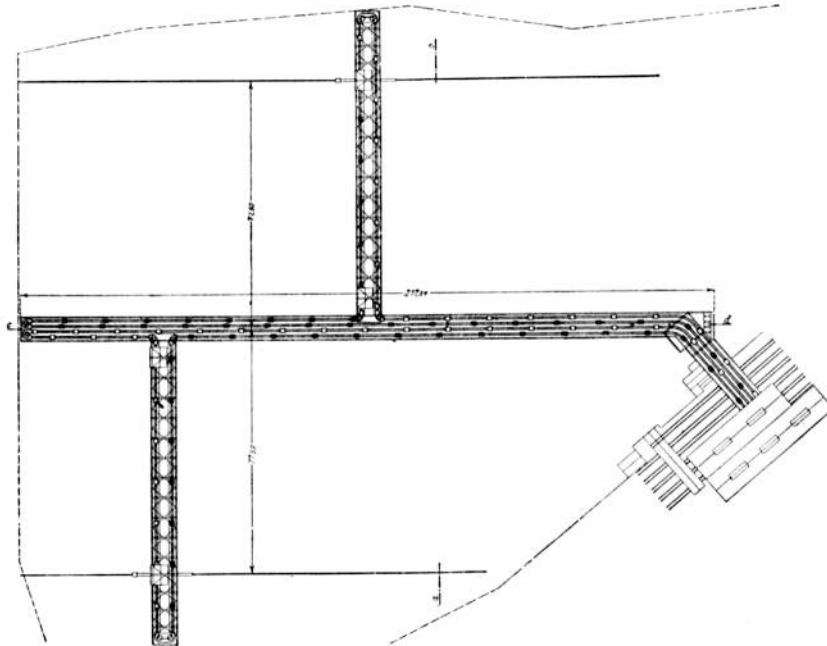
Sturz- und Verladeanlage auf der Radzionkaugrube. Grundriß.
